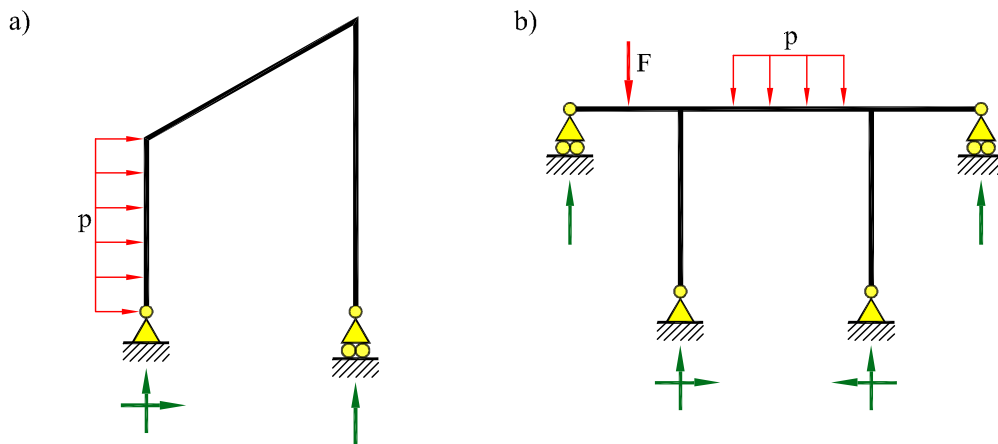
Estructuras reticuladas planas: (a) isostática (b) hiperestática
